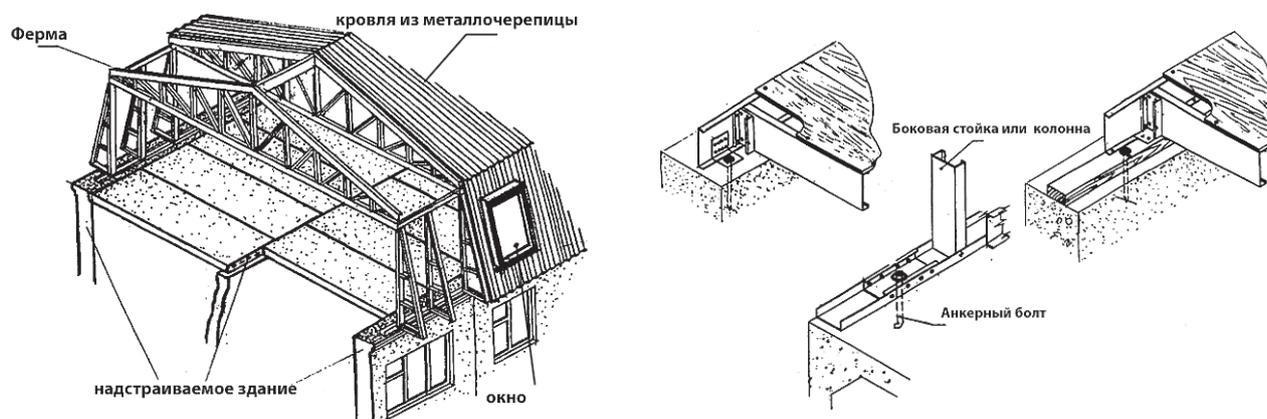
Типовые узлы надстройки здания из ЛСТК с опиранием на существующие элементы
